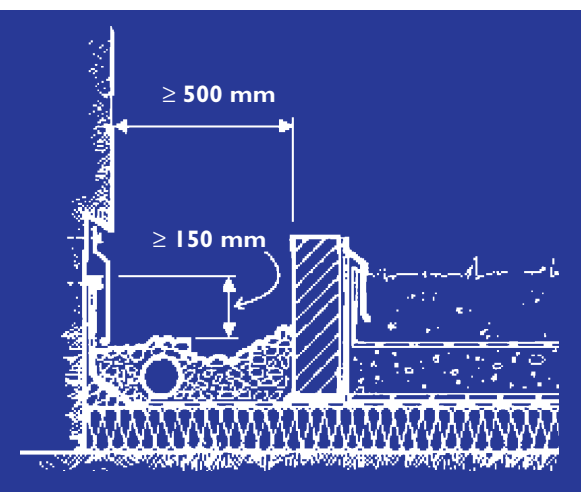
Solin avec barrière de gravier et égout de toit à la jonction mur-toit
